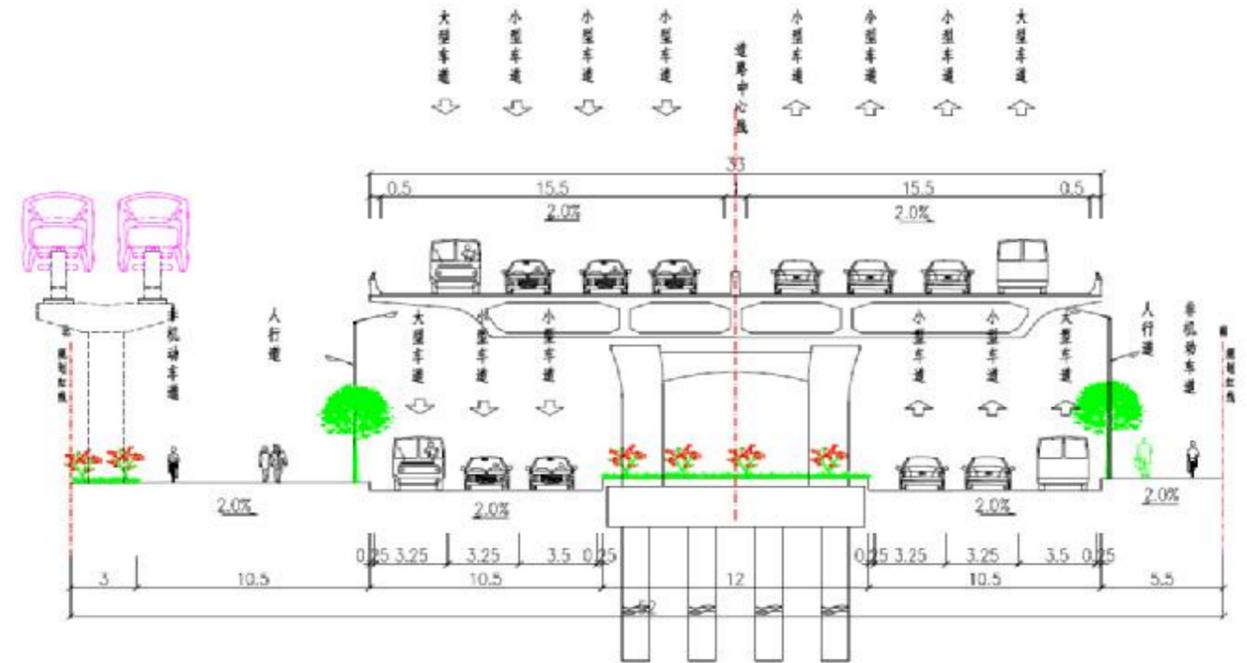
西港路~光华路段横断面图（尺寸单位：m）
